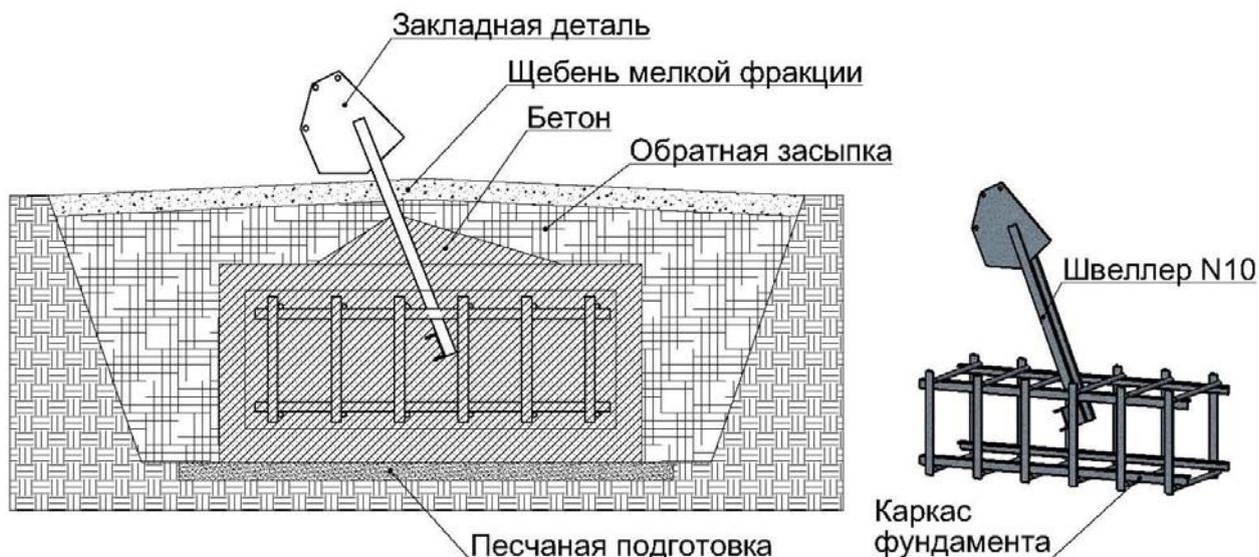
Анкер крепления оттяжек (установка на фундаменте).
